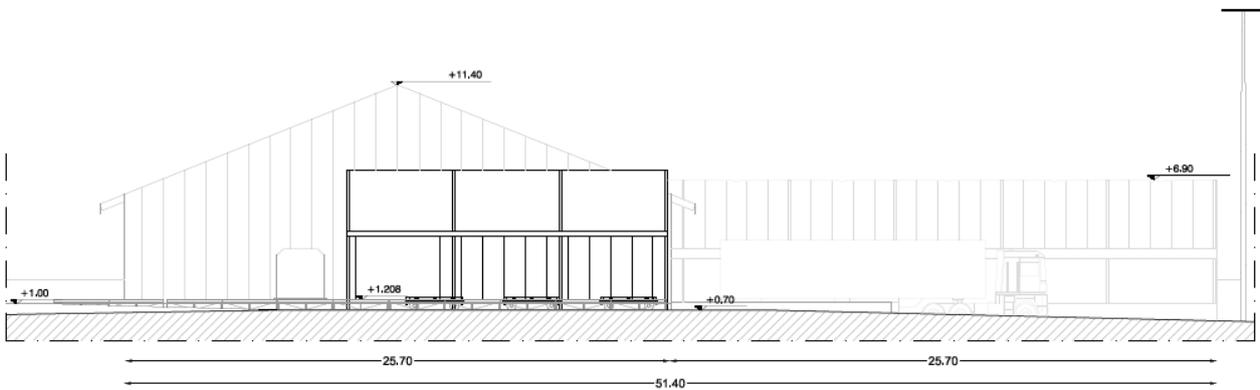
Prospetto Sud/Est tipo tensostruttura
